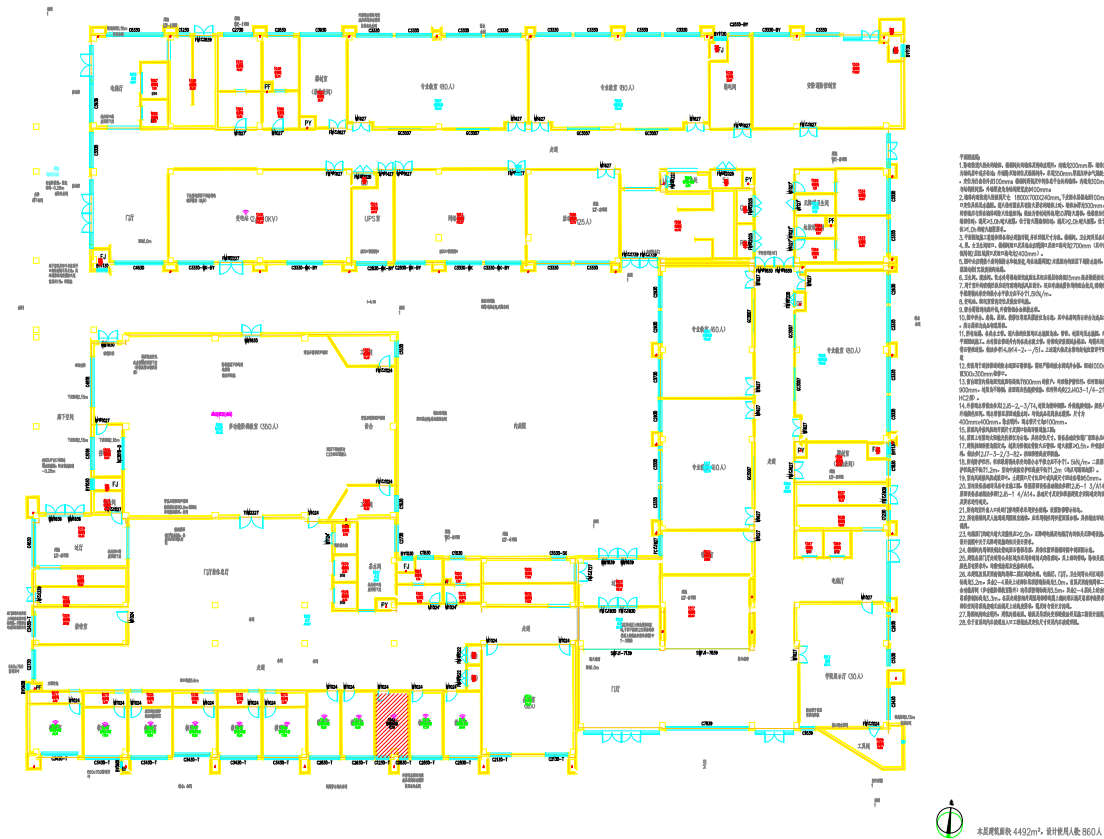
受建筑外部噪声影响的典型房间楼层平面图
